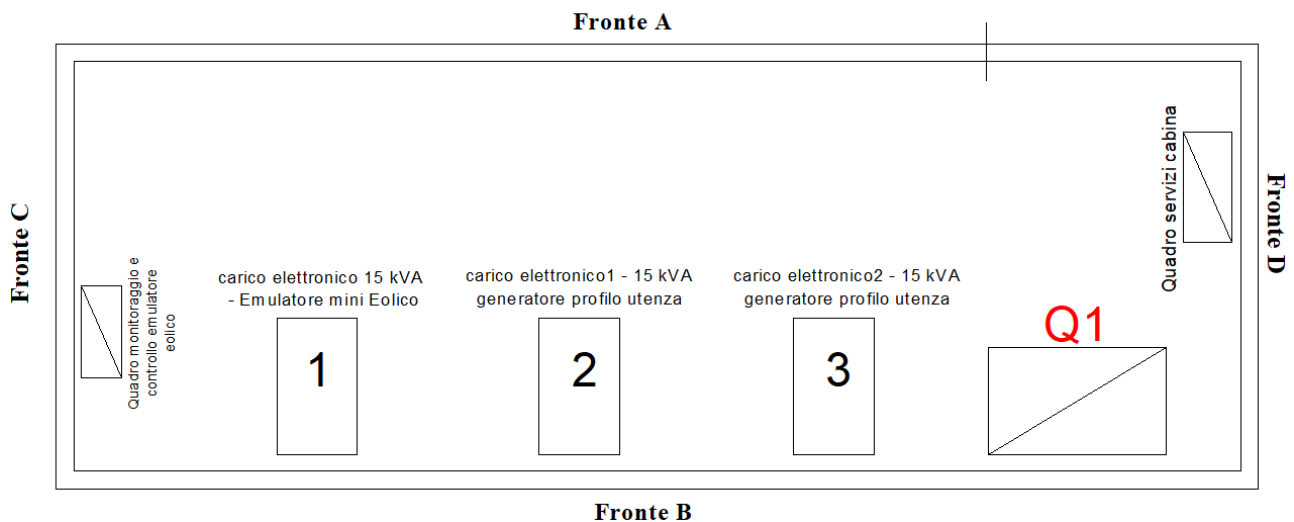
planimetria nuova cabina in progetto con indicazione della posizione dei nuovi componenti del sistema ibrido S.A.P.I.EN.T.E. - Soluzione C
